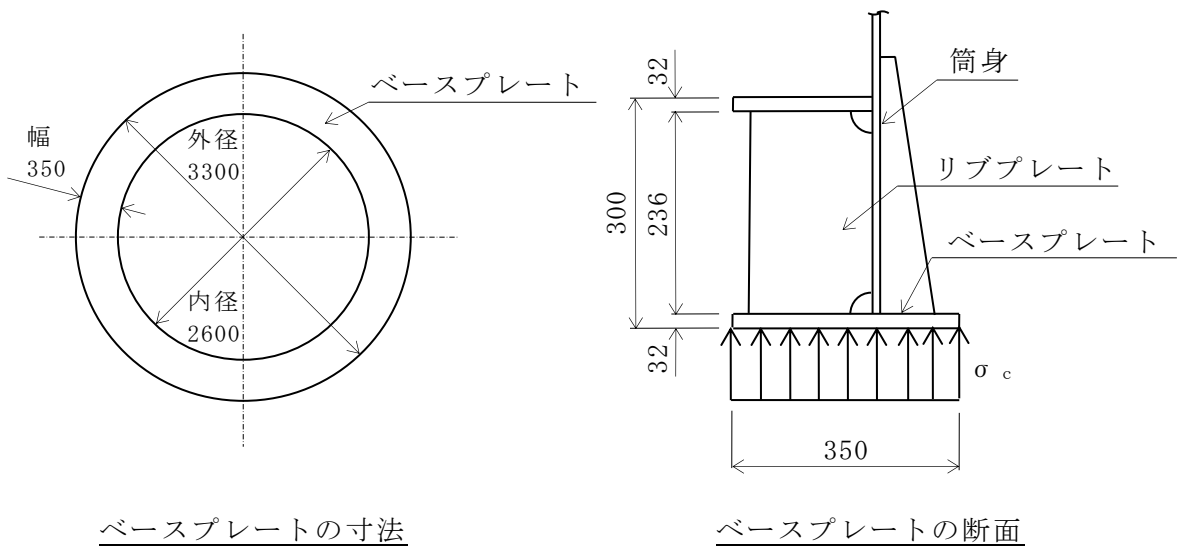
ベースプレートの概要図及びコンクリートの圧縮力分布図（単位：mm）
